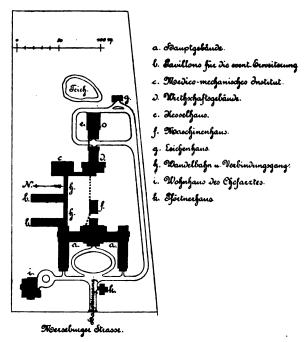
Krankenhaus "Bergmannstrost" in Halle a. S. Lageplan.
